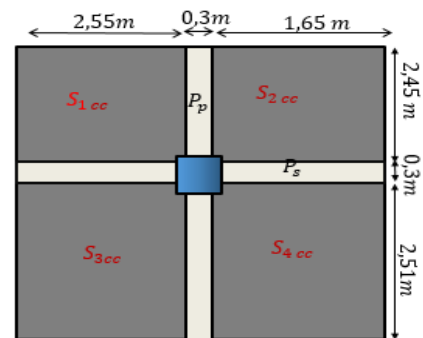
Poteau « P1 » de la descente de charge terrasse inaccessible
